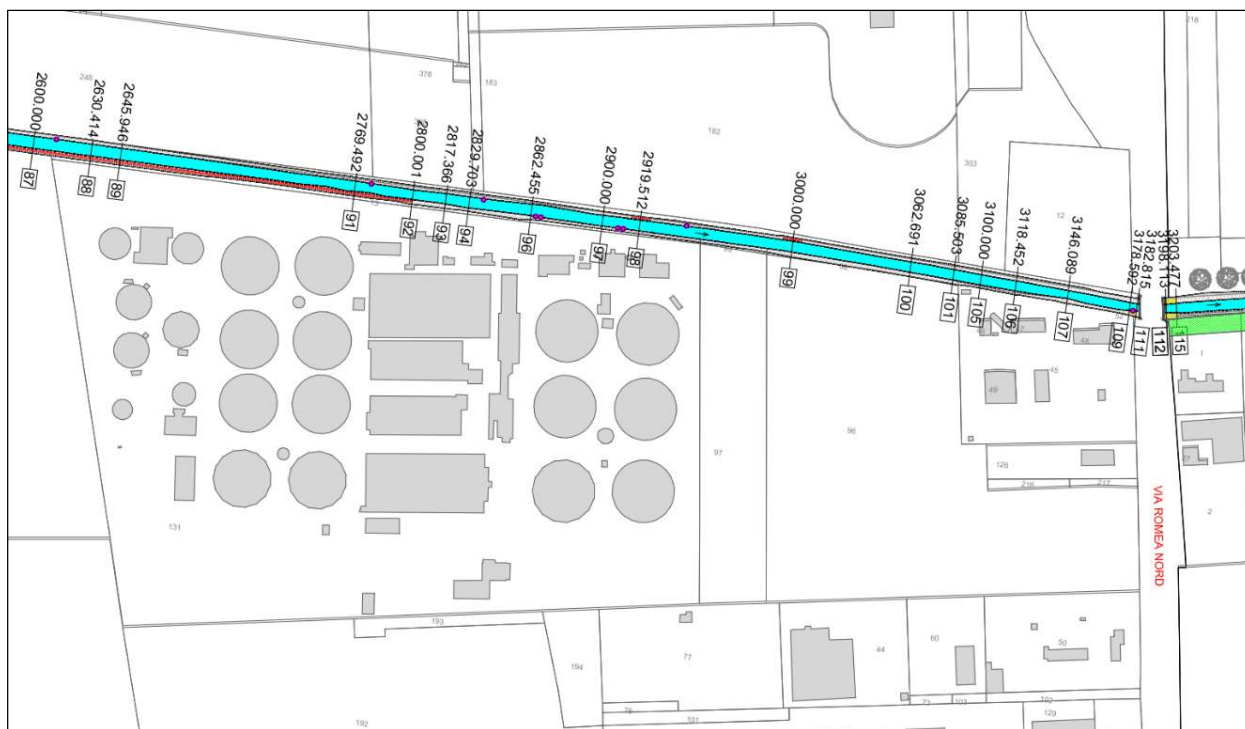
Estratto planimetria di progetto dell'intervento di bonifica ed allargamento dello scolo consorziale Fagiolo in Comune di Ravenna - 1° Stralcio
